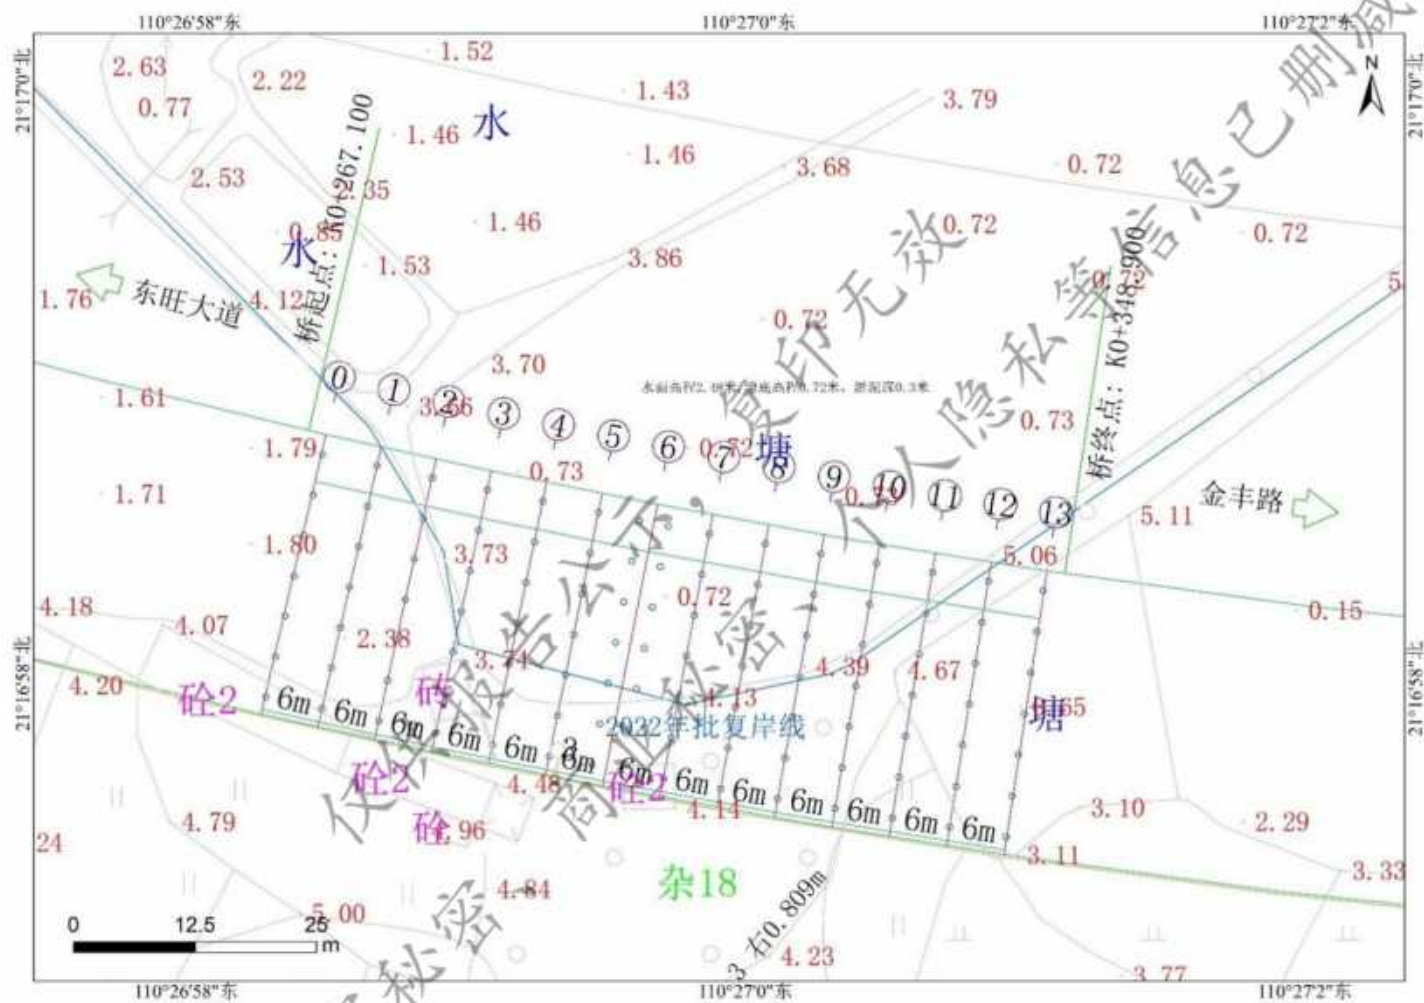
海顺路 1 号桥总平面布置图 (1)
